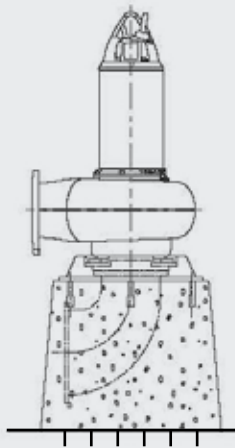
Vertikale tauchbare Grundfos Trockenschacht-Klärwasserpumpe auf Betonfundament mit Lagernägeln im Boden
